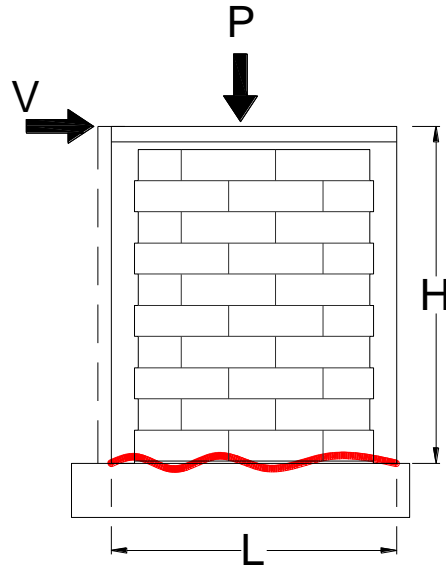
Grieta por deslizamiento relativo de un muro confinado.
